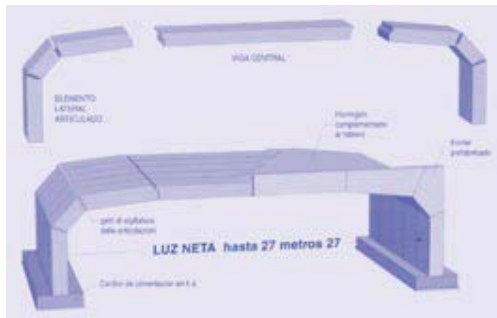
Estructuras prefabricadas para dos vías (tres elementos)
